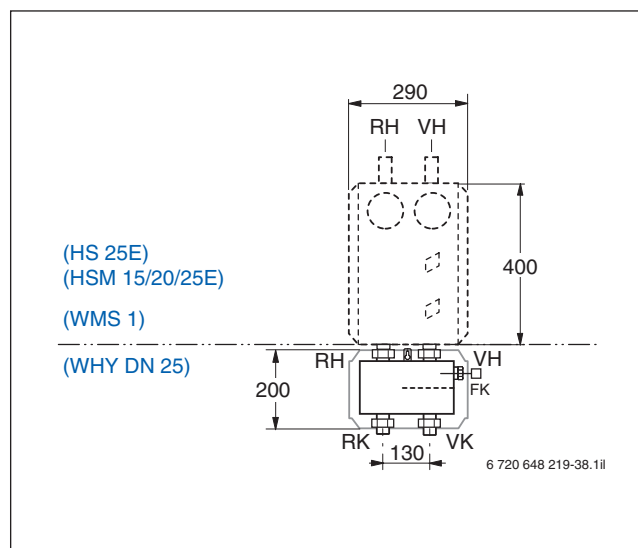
Wymiary połączeń systemów rozdzielacza obiegu grzewczego ze zintegrowanym sprzęgłem hydraulicznym do dwóch obiegów grzewczych (wymiały w mm)
